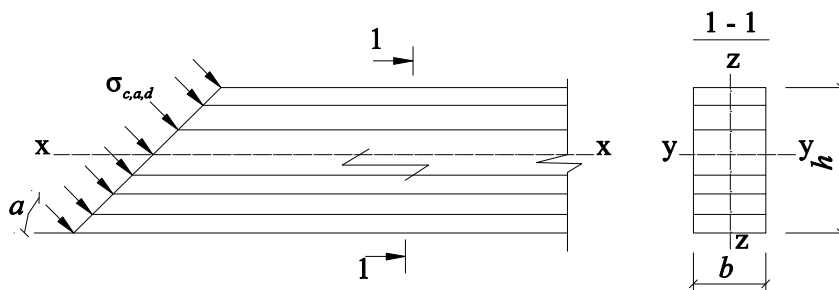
Общий вид элемента, подверженного сжатию под углом α к волокнам
